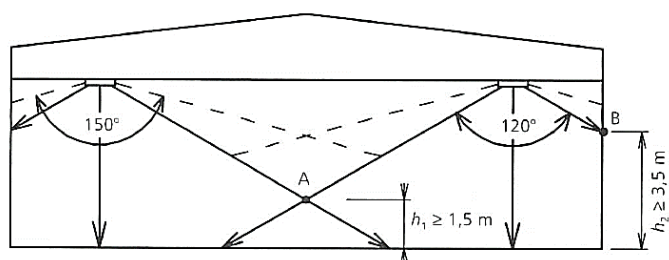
Rozmístění zářičů provedení alfa [5]
